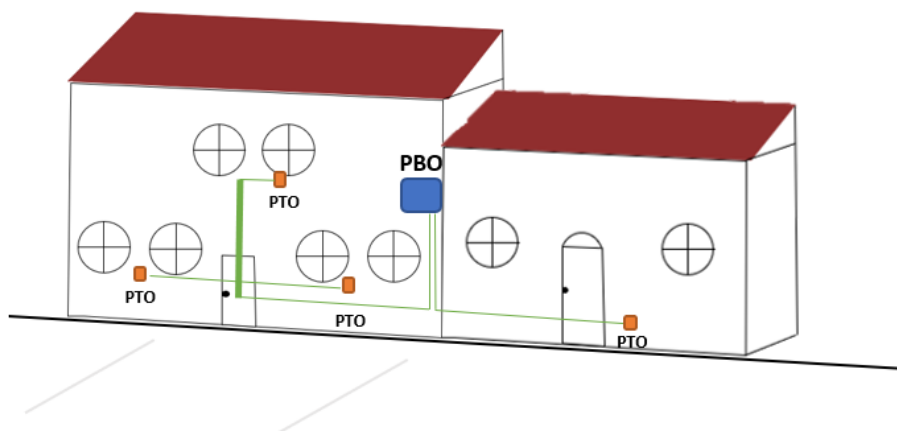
Schéma illustratif d'un raccordement depuis un PBO en façade
